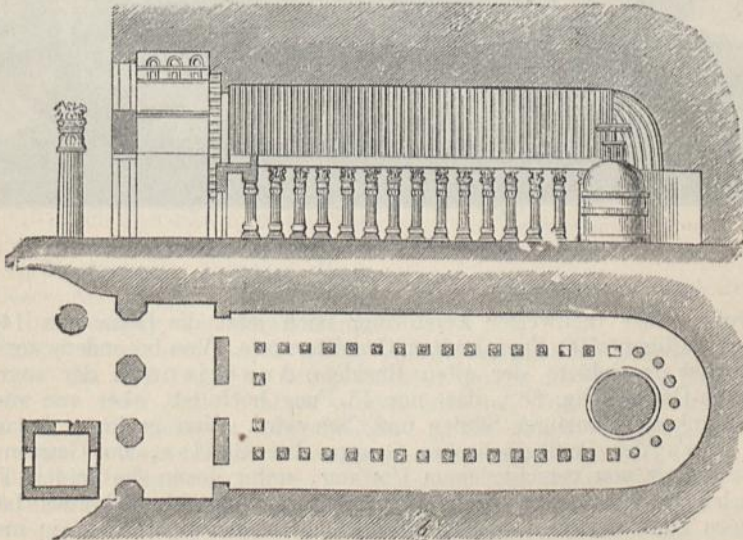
Grotte von Karli. Grundriss und Durchschnitt.
